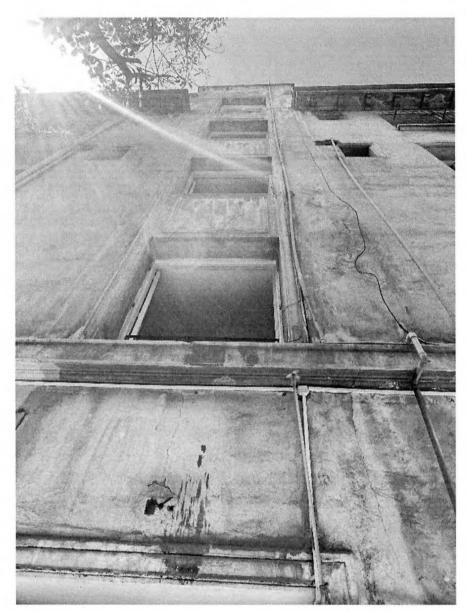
Fisuras en ventanas y muros en fachada norte, patio interior.
